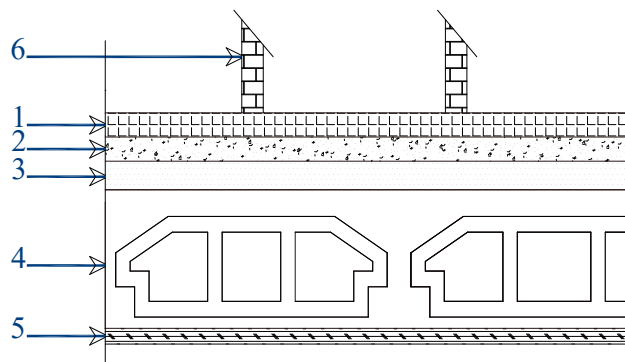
Coupe transversale de plancher étage courant (corps creux)
